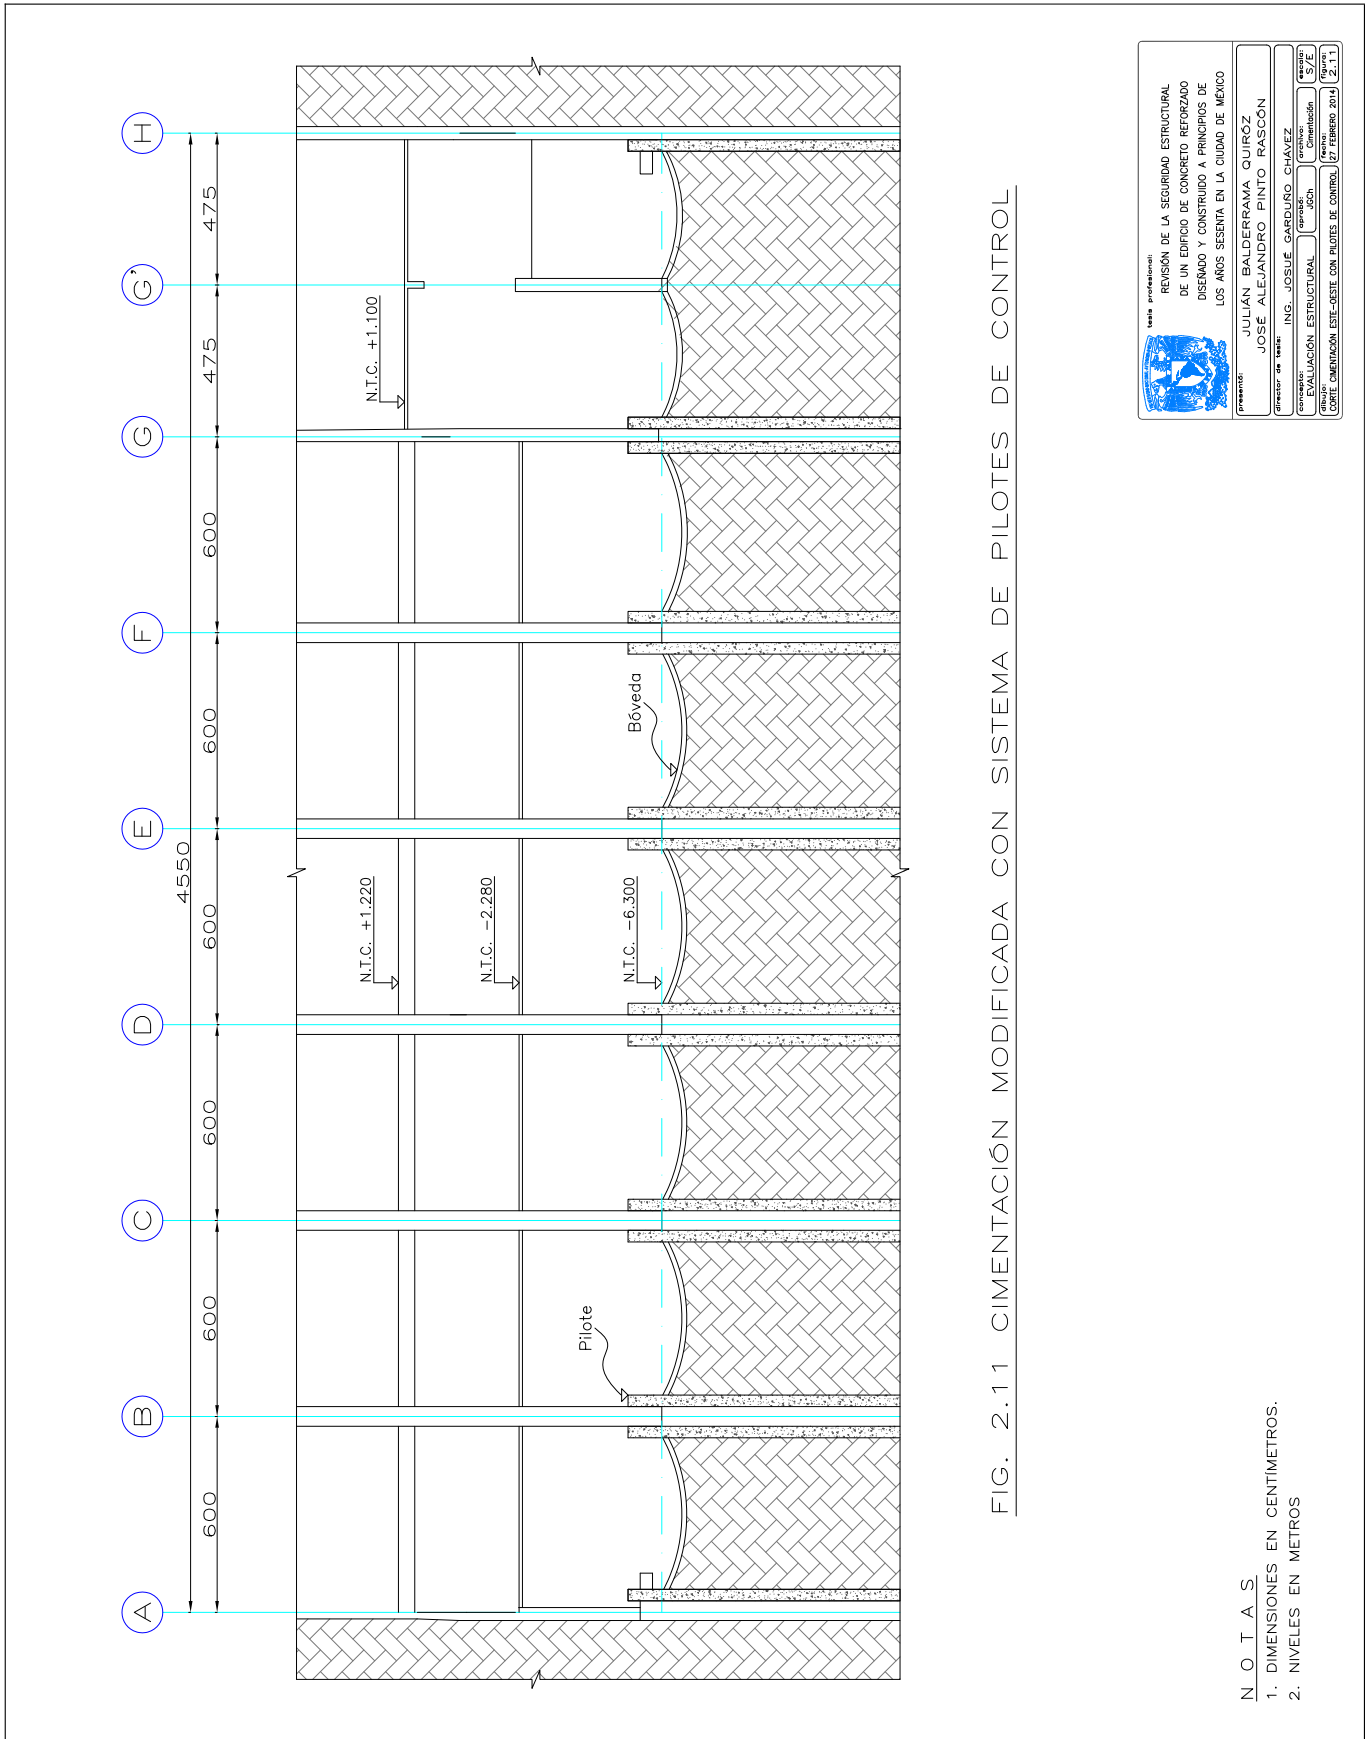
CIMENTACIÓN MODIFICADA CON SISTEMA DE PILOTES DE CONTROL
